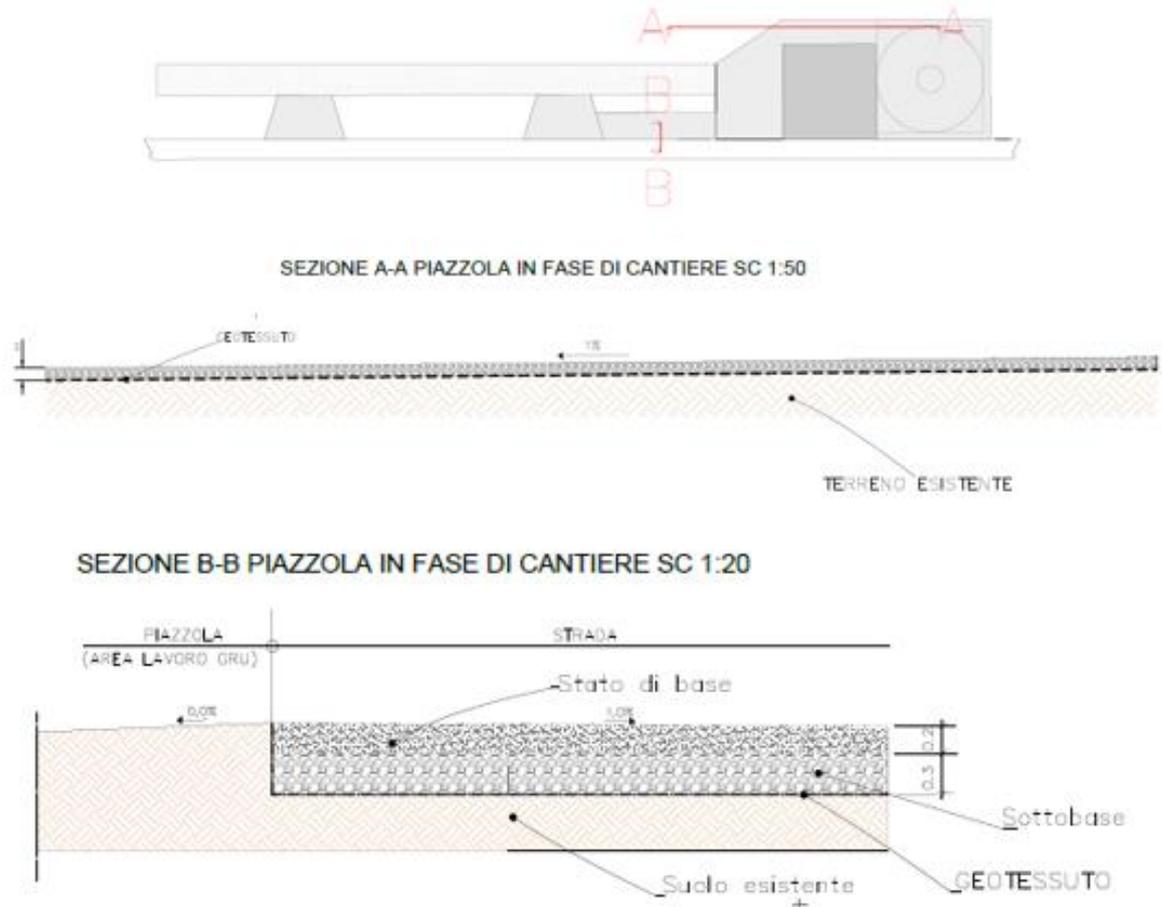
Sezione della piazzola (configurazione "Just in Time") in fase di cantiere
